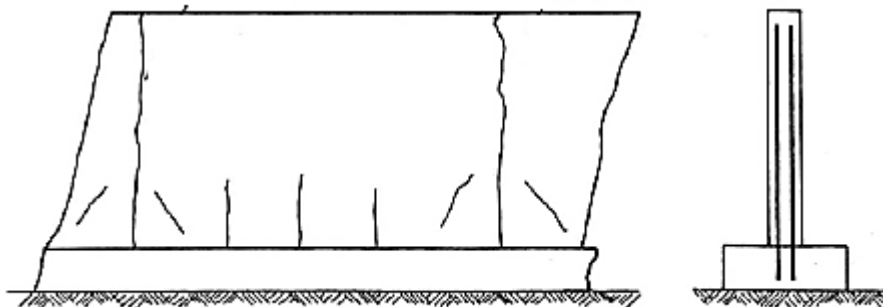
Grietas de un muro por contracción térmica inicial
